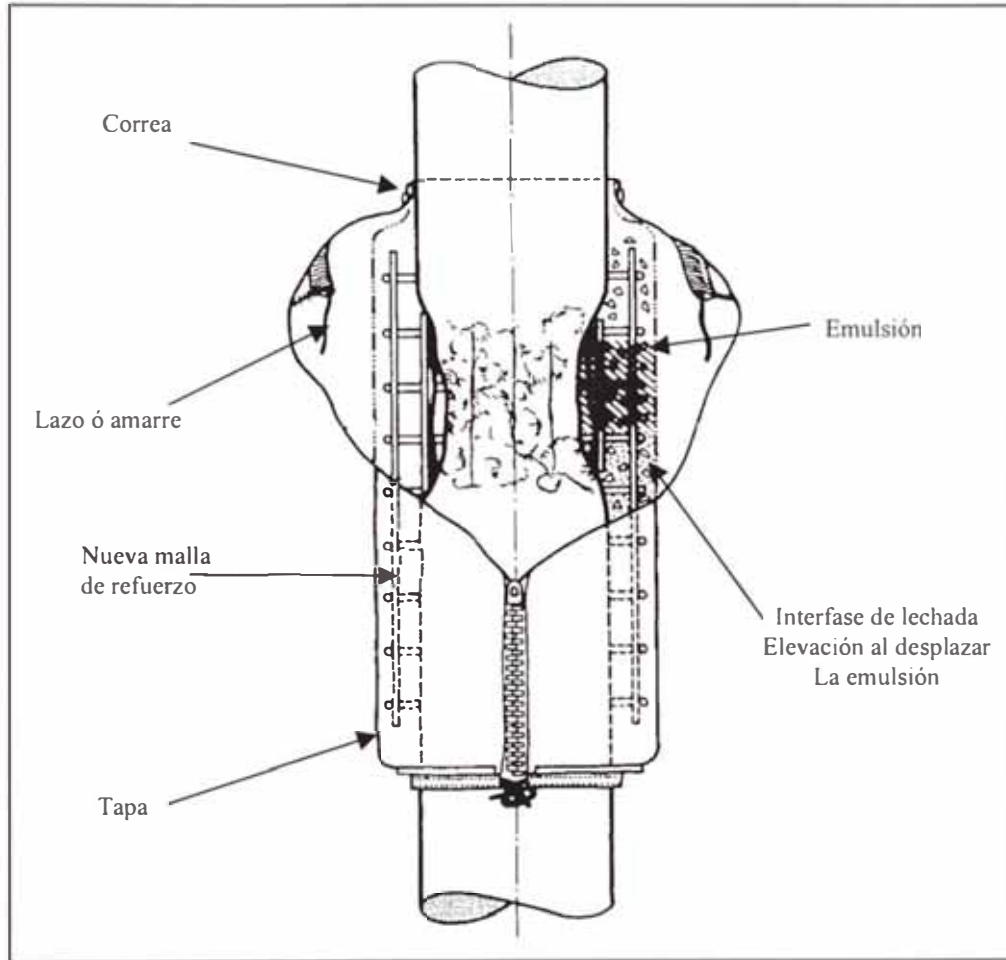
Detalles de una reparación que usa encofrado flexible.
